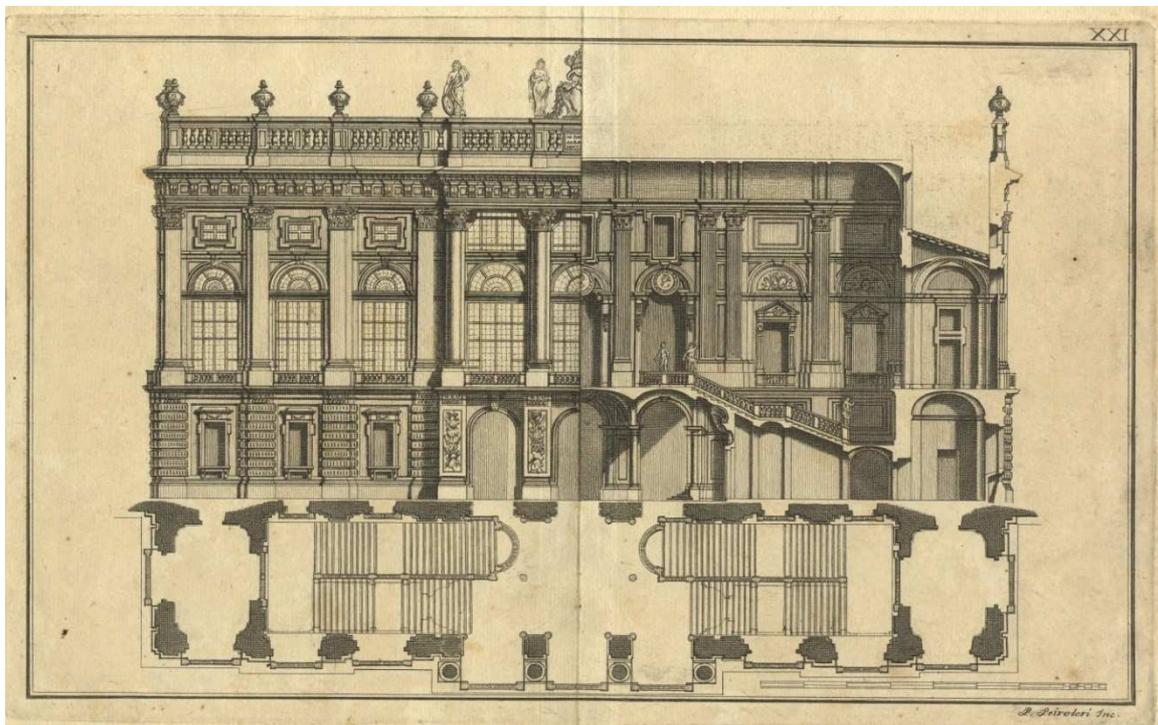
Pietro Peiroleri su disegno di Bernardo Antonio Vittone, Pianta, prospetto e sezione dello scalone e facciata di Palazzo Madama a Torino, incisione da B. A. Vittone, *Istruzioni diverse...*, Lugano 1766, tav. XXI
